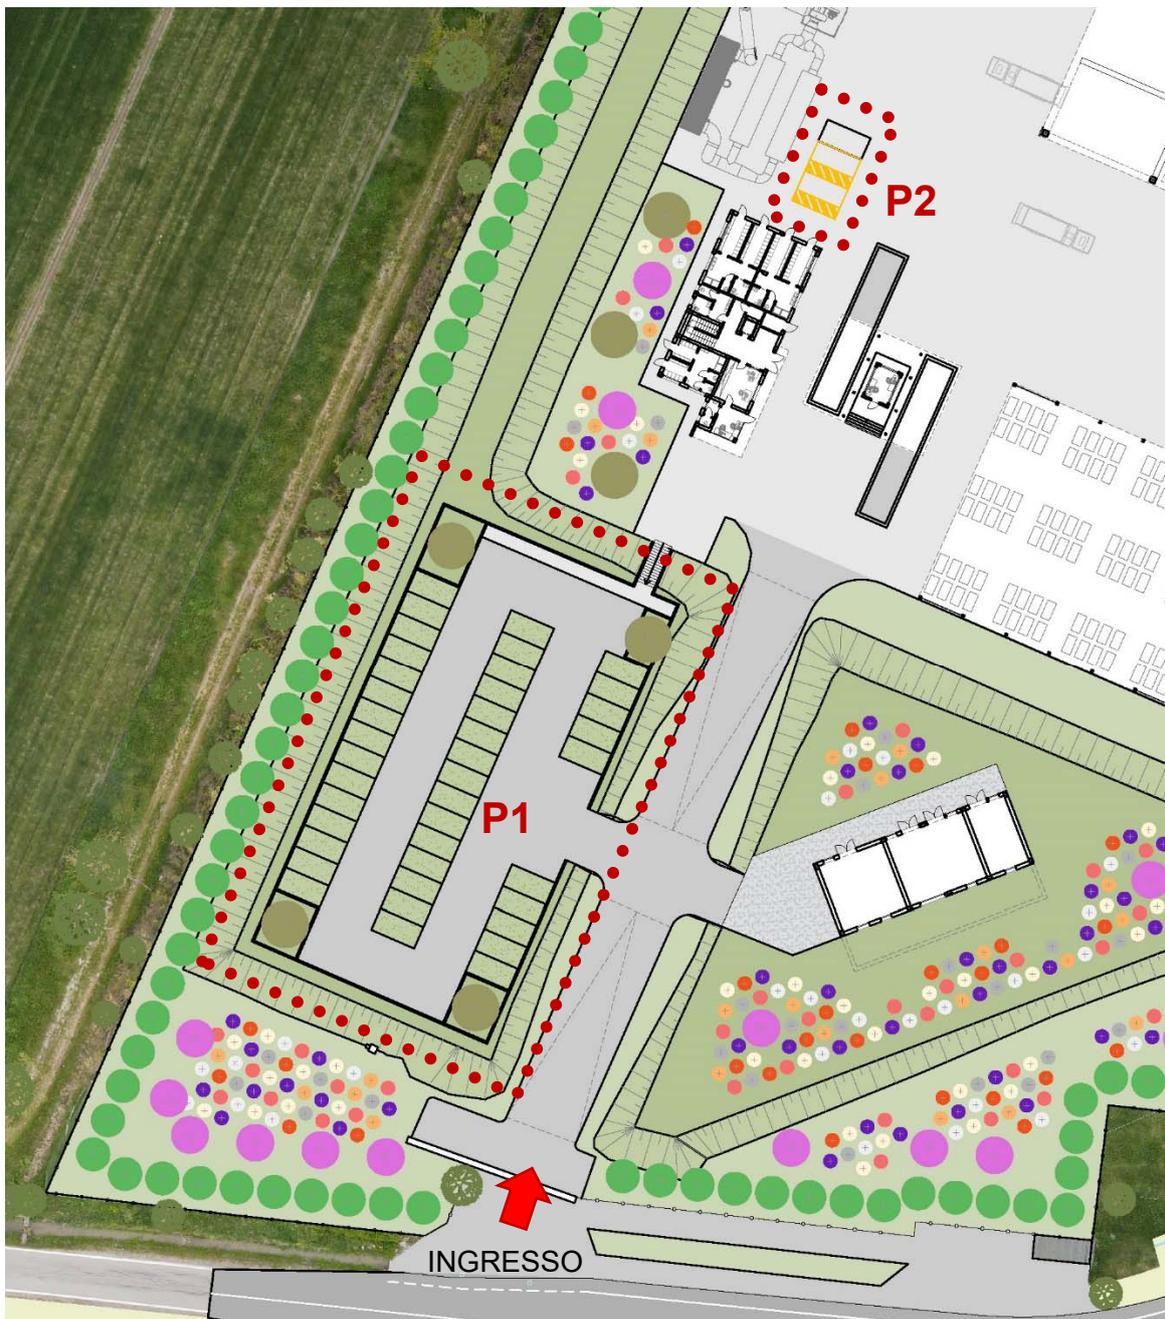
Planimetria area d'ingresso con indicazione delle aree destinate a parcheggio
